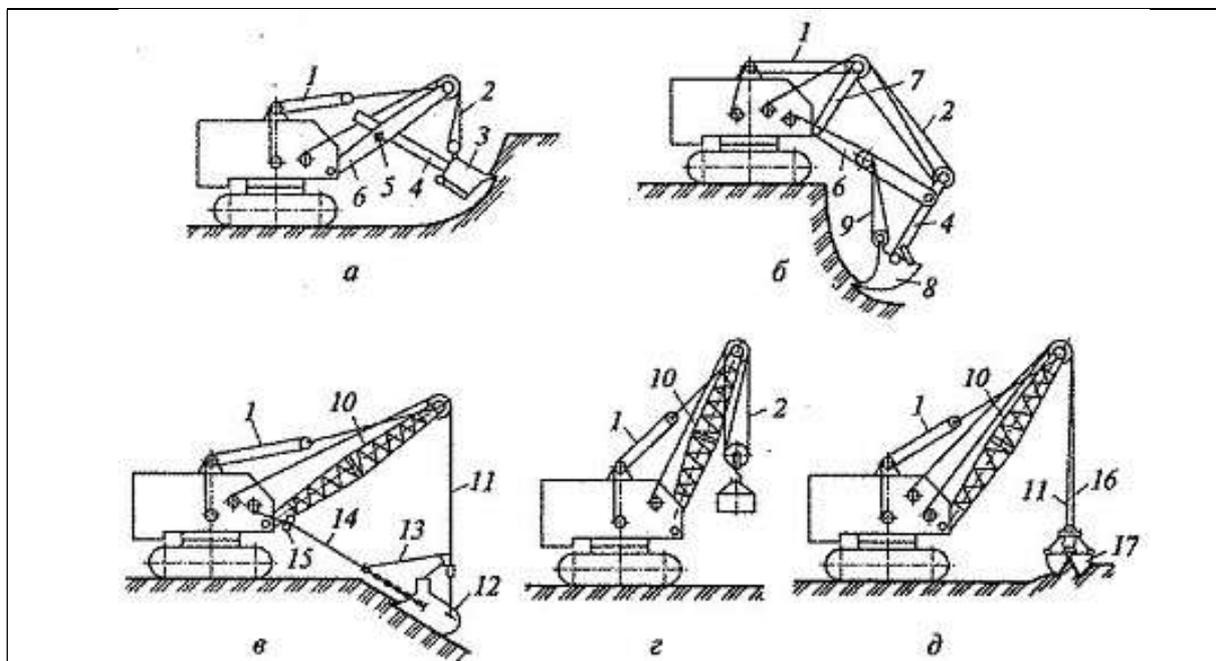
Основные виды сменного рабочего оборудования оборудования строительных экскаваторов с механическим приводом: а – прямая лопата; б – обратная лопата; в – драглайн; г – крановое оборудование; д – грейферное оборудование: 1 – полиспаст подъёма стрелы; 2 – полиспаст подъёма ковша (или груза); 3,8 – ковш; 4 – рукоять; 5 – напорный механизм; 6 – стрела; 7 – стойка; 9 – полиспаст тяговый; 10 – решётчатая стрела; 11 – подъёмный канат; 12 – ковш совкового типа; 13 – разгрузочный (опрокидной) канат; 14 – тяговый канат; 15 – механизм наводки тягового каната; 16 – замыкающий канат; 17 – грейферный двухчелюстной ковш
